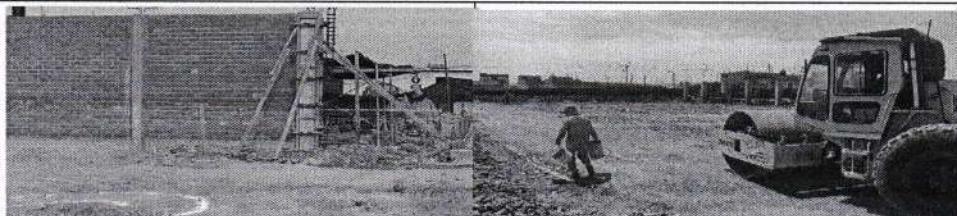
y 03: encofrado de columnas tipo caravista y decompañado de subsasante
